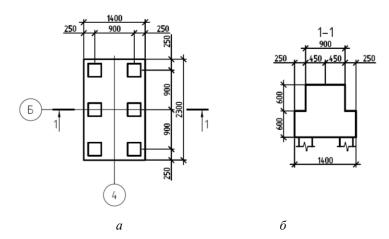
Схема расположения свай (a) и поперечный разрез ростверка (δ)
